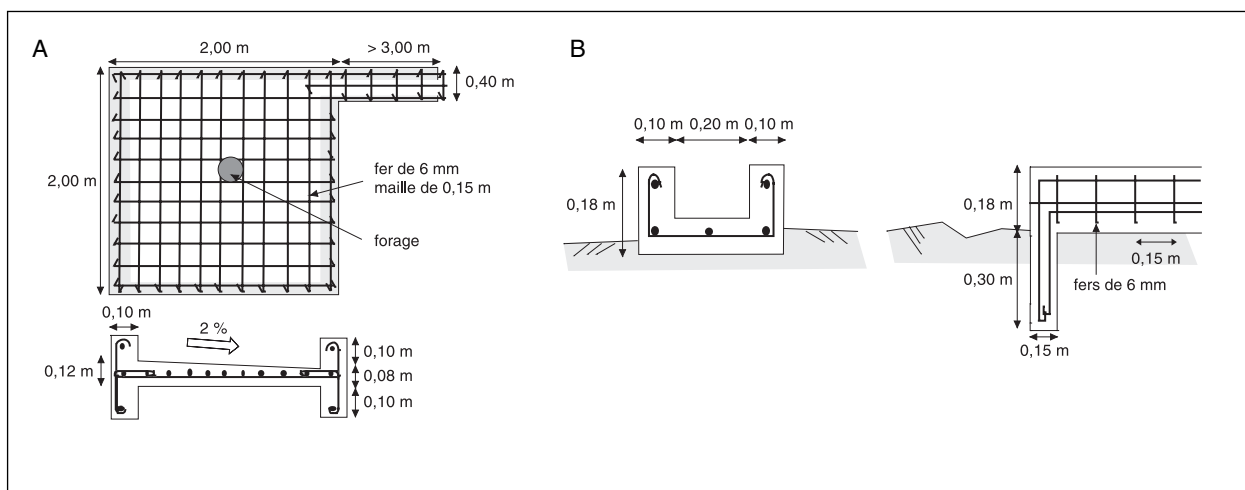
Plan de ferrailage. A, dalle. B, rigole.
